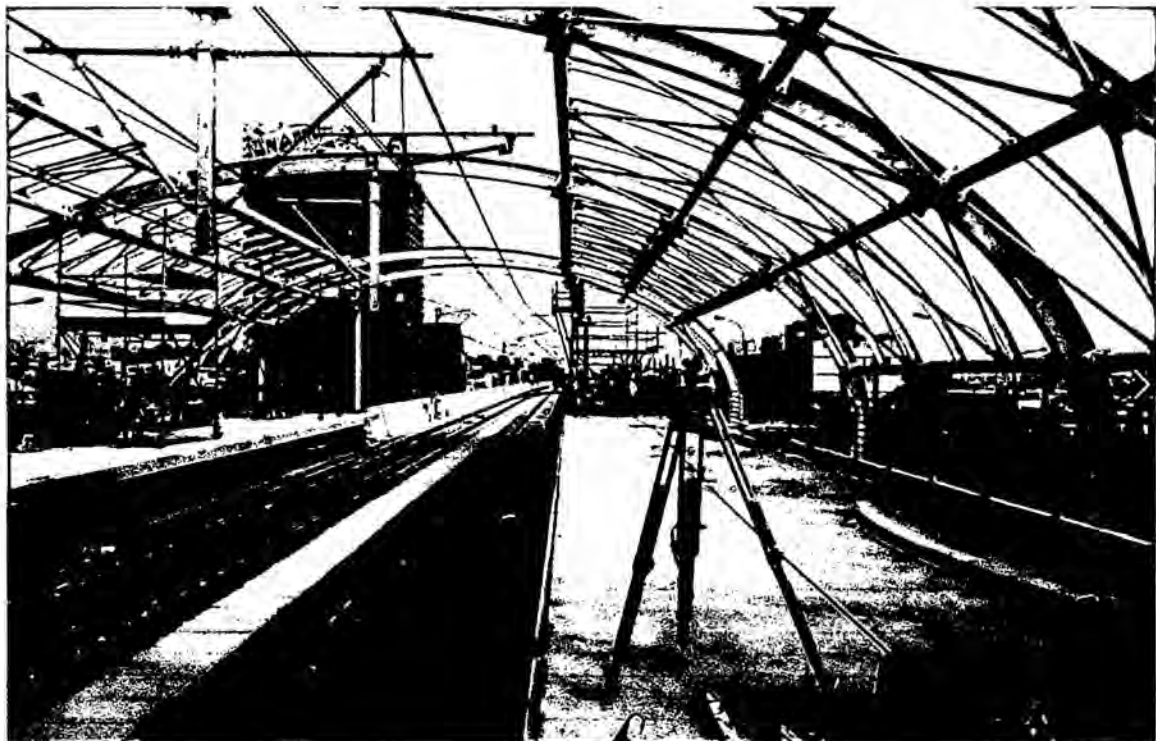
Foto extraído del Tramo 1 (Cubierta Metálica Estación)
